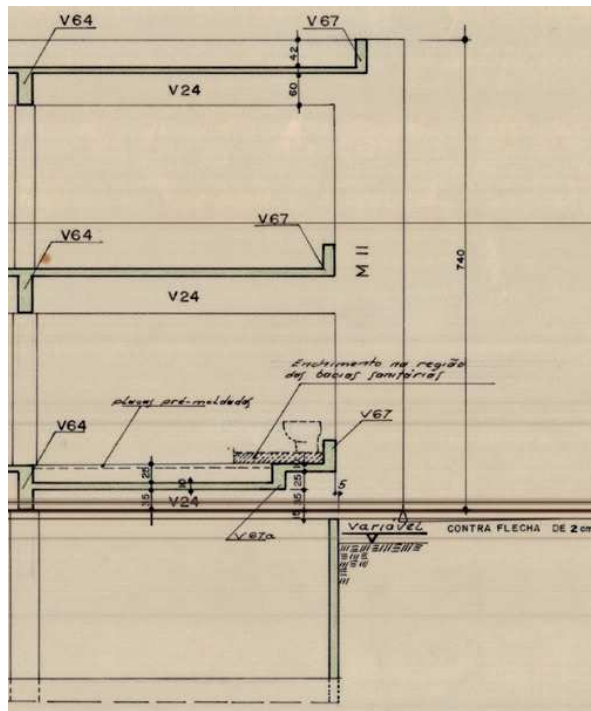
Placas pré-moldadas para o piso dos banheiros públicos – projeto estrutural 1971
